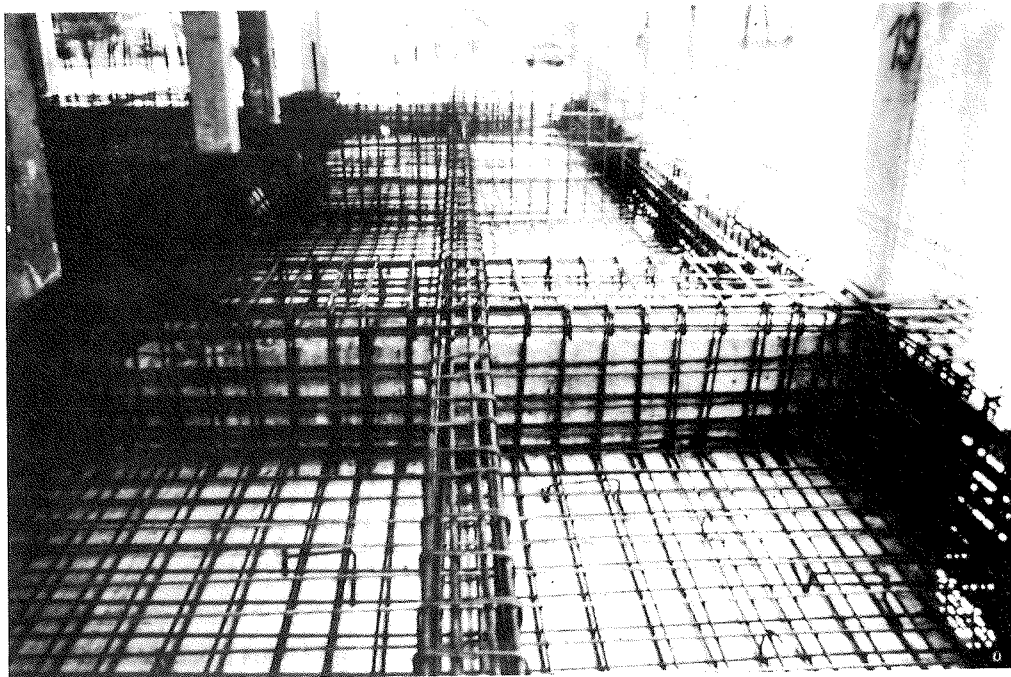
Esecuzione dell'irrigidimento orizzontale al livello delle strutture di fondazione. Sono stati realizzati rinforzi delle travi di collegamento e campi di platea per tutto lo sviluppo dell'edificio
